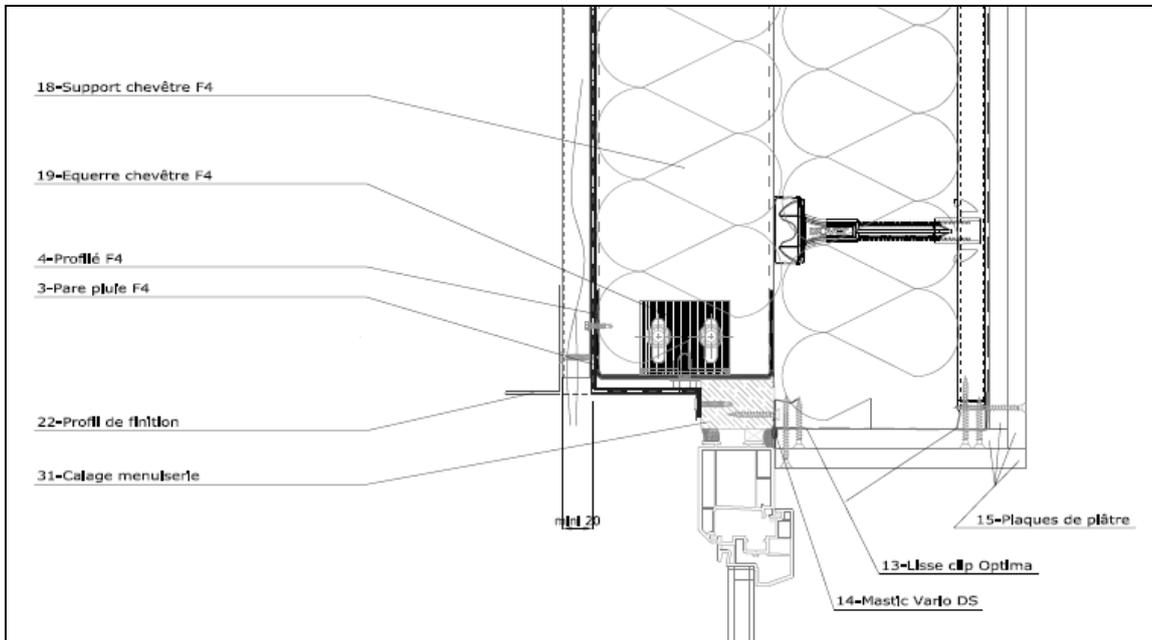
Traitement des baies pose en tunnel – Partie haute
